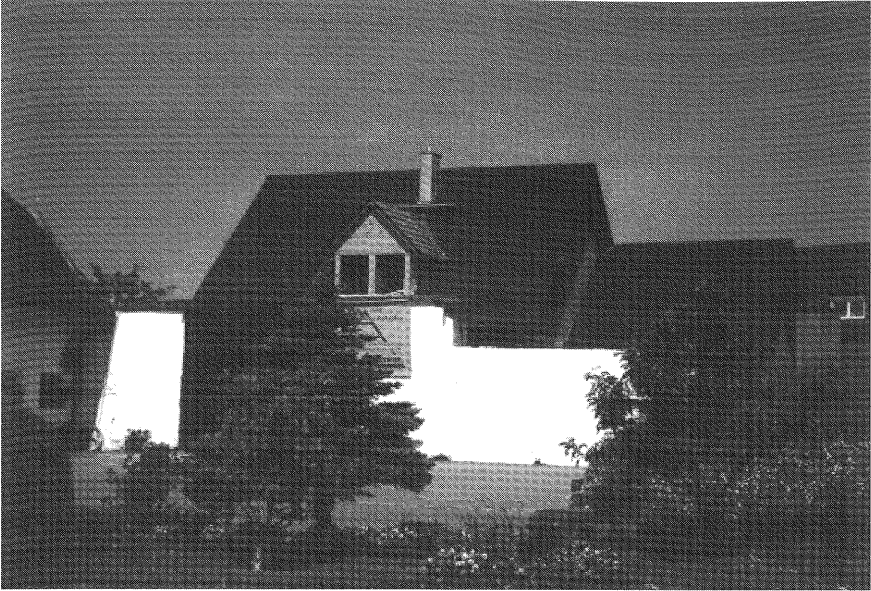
Errichtung eines neuen Wohnhauses innerhalb der Grundmauern einer ehemaligen Scheune. (Großenseebach, Photo: B. Ciolek)
